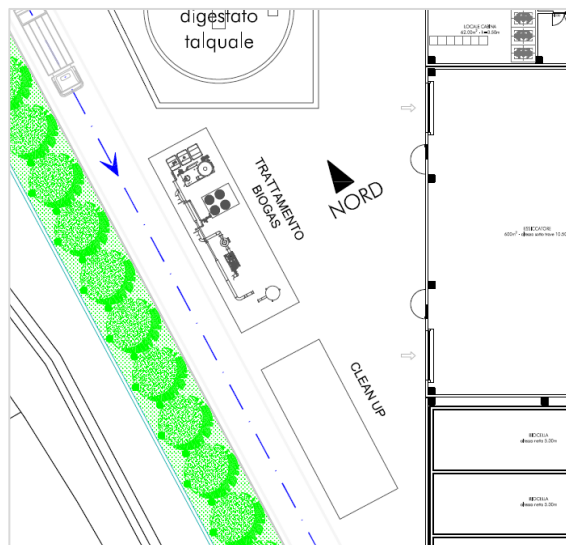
Area trattamento biogas_ Stralcio dalla planimetria generale
